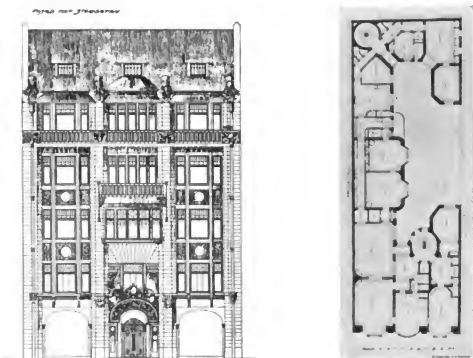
, 47. Fassade und Grundriss eines Wohnhauses an der Storgata in Stockholm.
